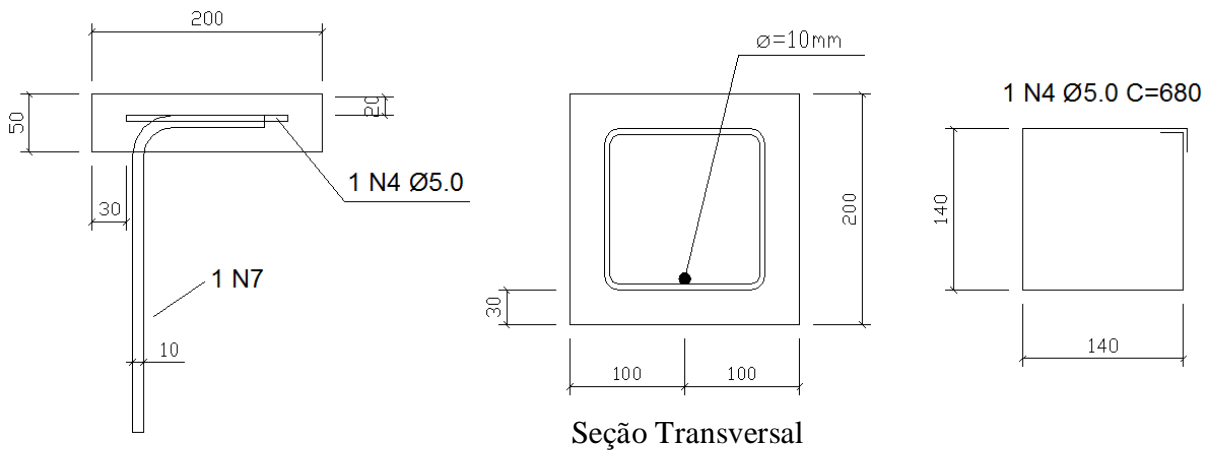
Detalhe do modelo de arrancamento com barras de 10 mm com gancho e com estribo (dimensões em mm)
